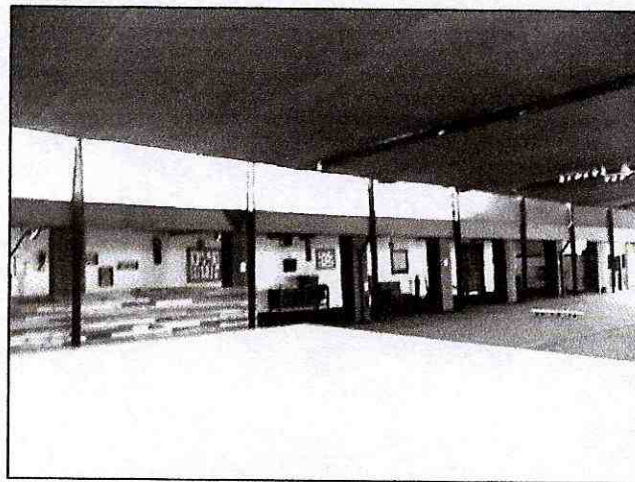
Fachada oeste de la carpa vista desde el interior.
